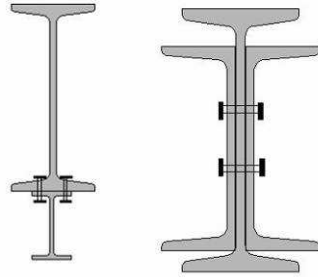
Consolidación de vigas mediante estructura metálica
